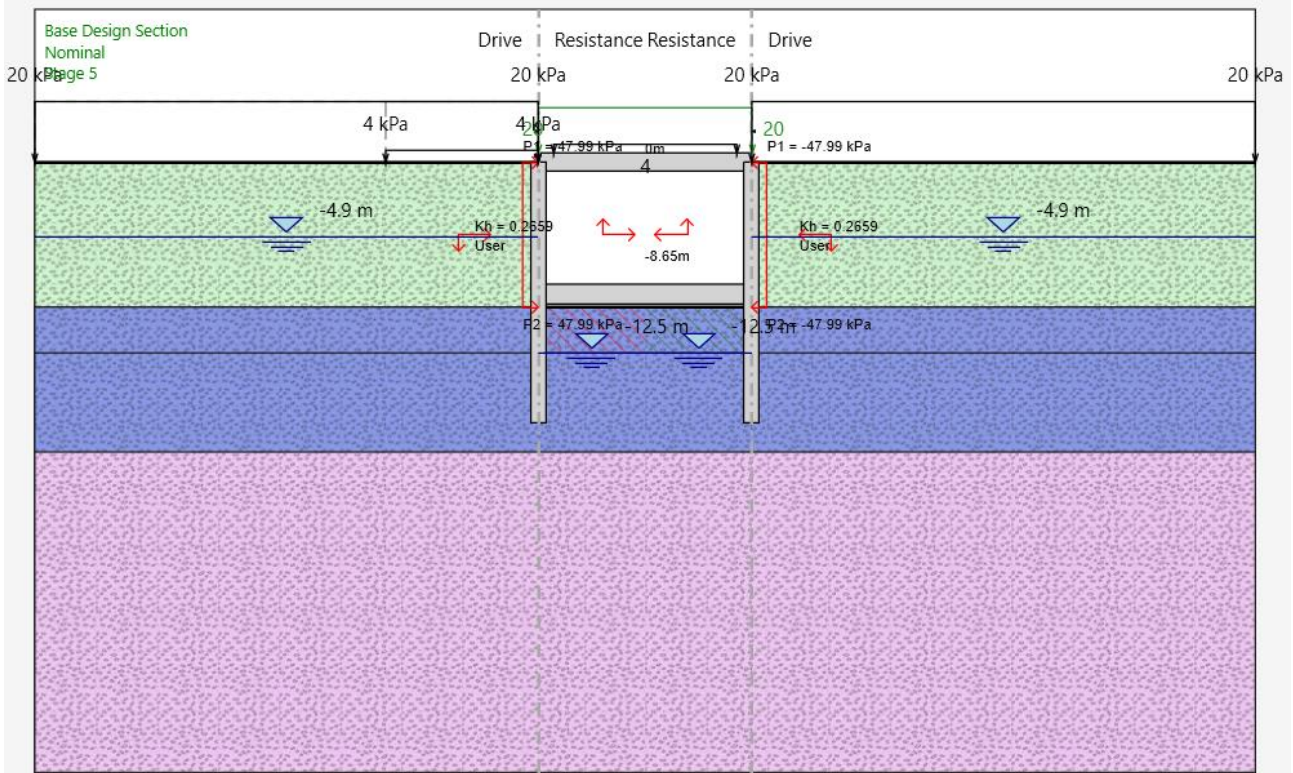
Fase 4 - Realizzazione della fondazione e riempimento
